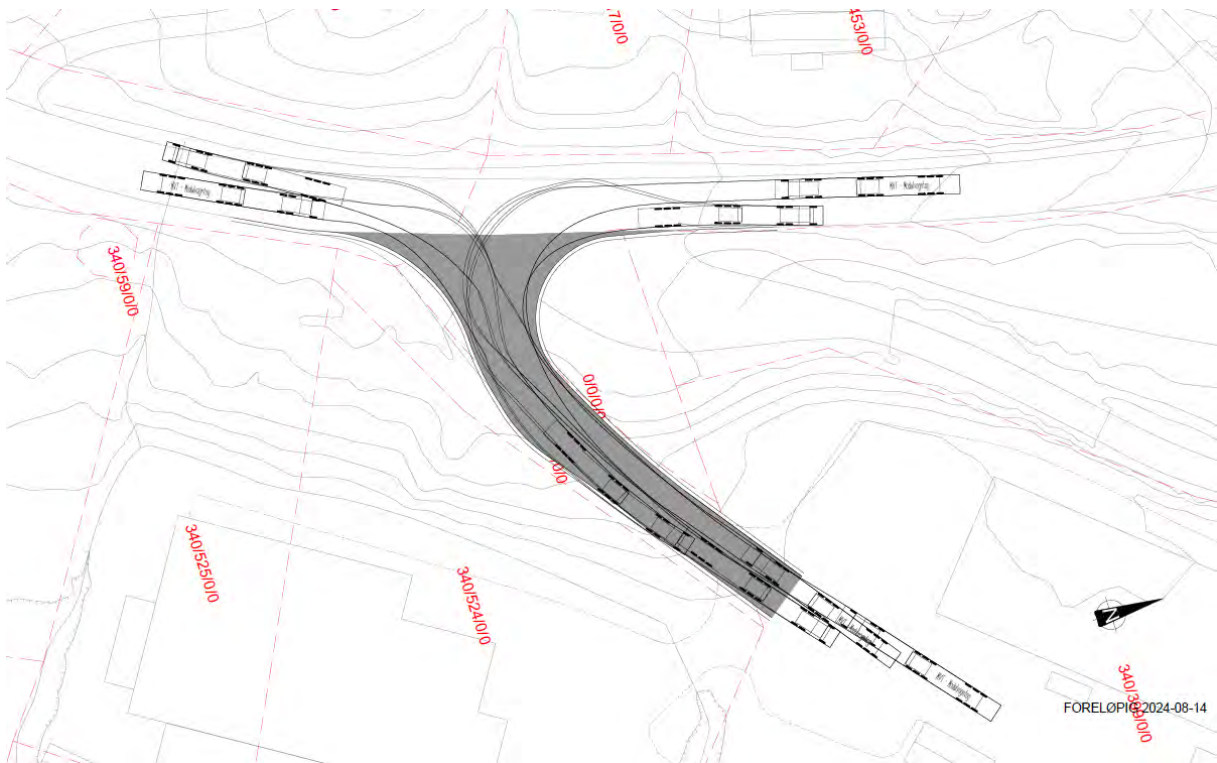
Markering av planlagte adkomster til planområdet. Avkjørsler fra E6 er vist i større detalj.
